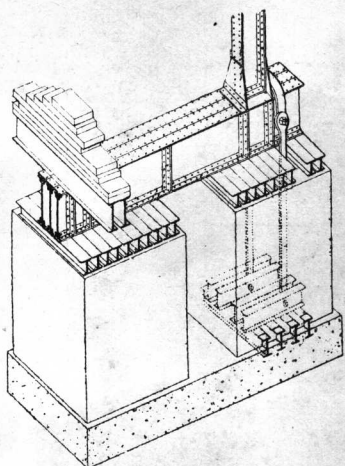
Cimientos de la AMERICAN SURETY BUILDING
